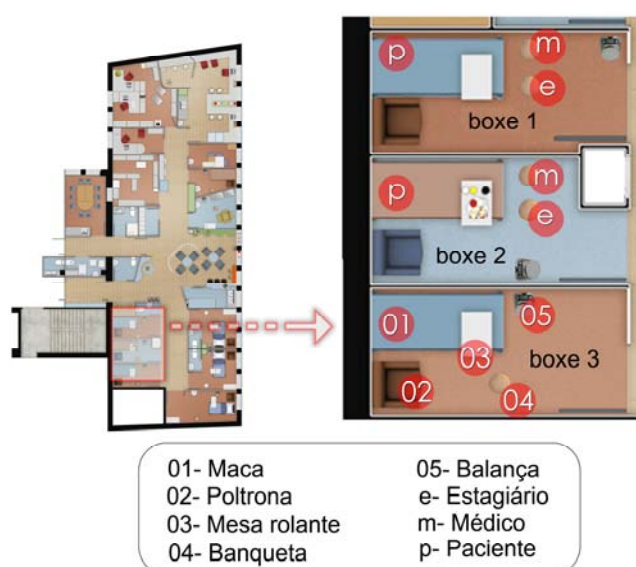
Planta de implantação e leiaute dos boxes 1, 2 e 3 – hospital-dia VIH posterior ao projeto
